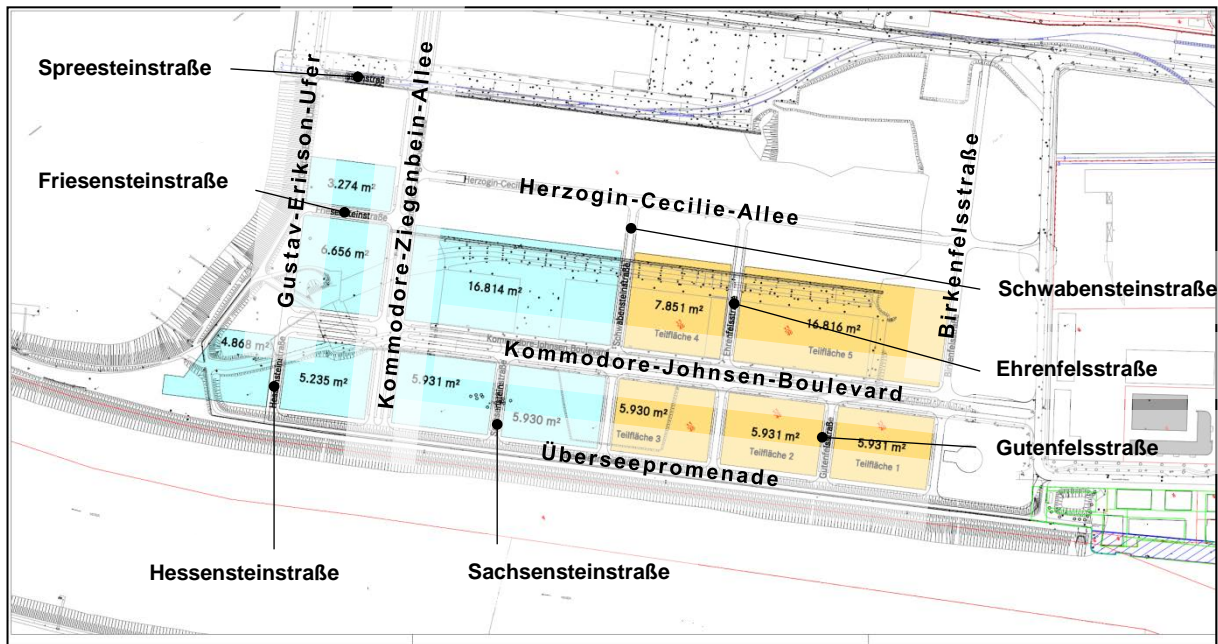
Bauabschnitte im Lageplan [gelb = erster Bauabschnitt, blau = zweiter Bauabschnitt]
